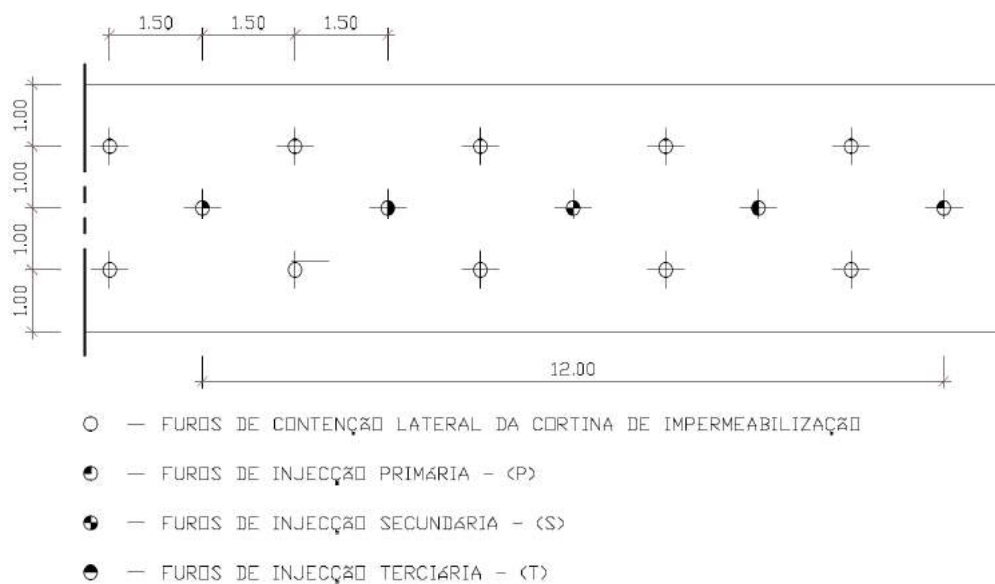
Planta do tapete de betão e dos furos de injeção
